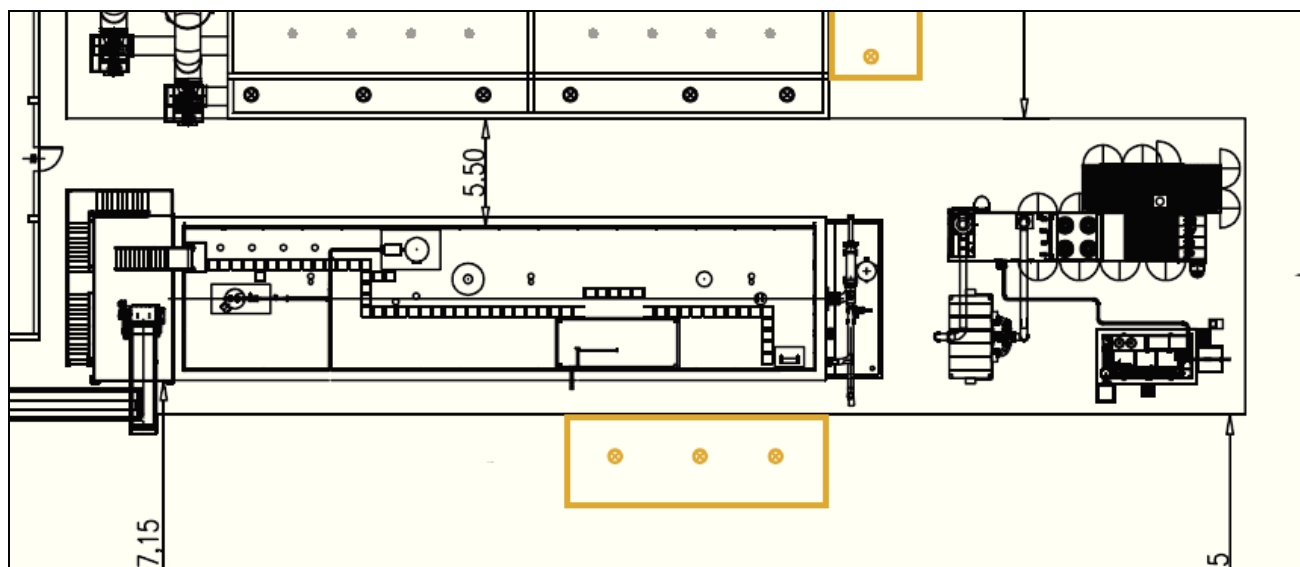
Stralcio planimetrico completo del secondo stralcio funzionale.
